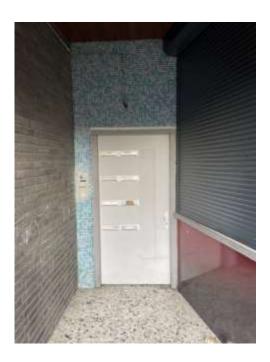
Hauseingangstür Kaiser-Friedrich-Straße 29
